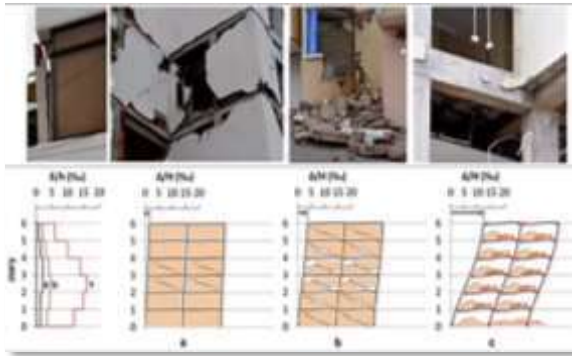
Edificio con mampostería relleno en Bahía, sismo 2016.
